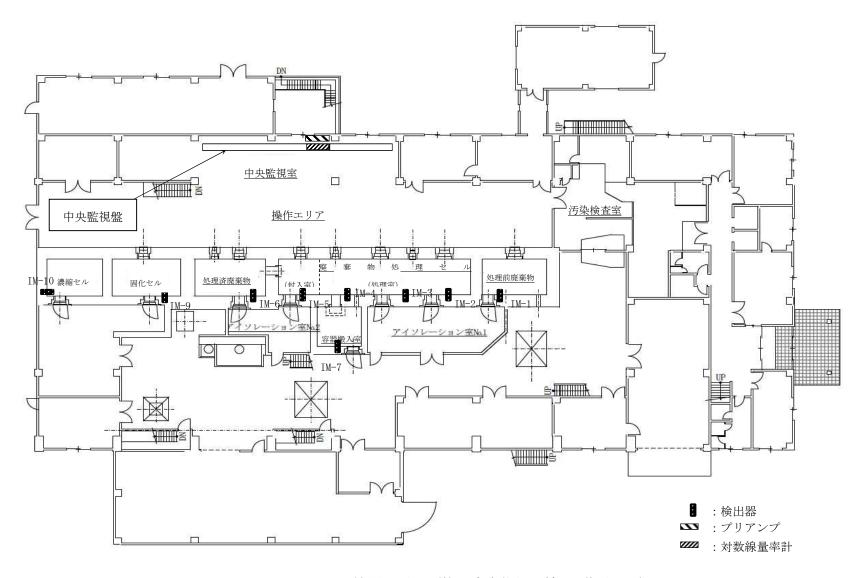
機器配置図 (第2廃棄物処理棟 1階平面図)
